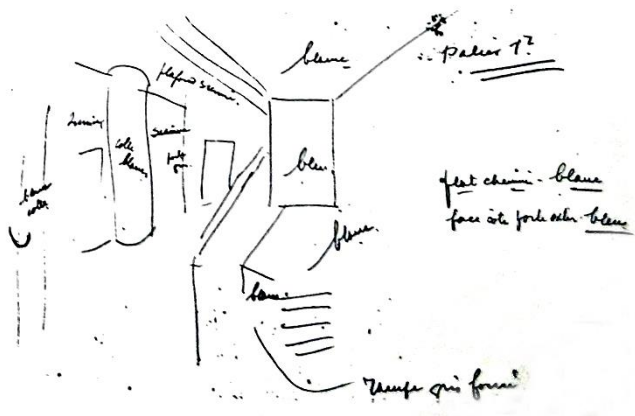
Planta primera mirando hacia el comienzo de las escaleras en la planta baja.
